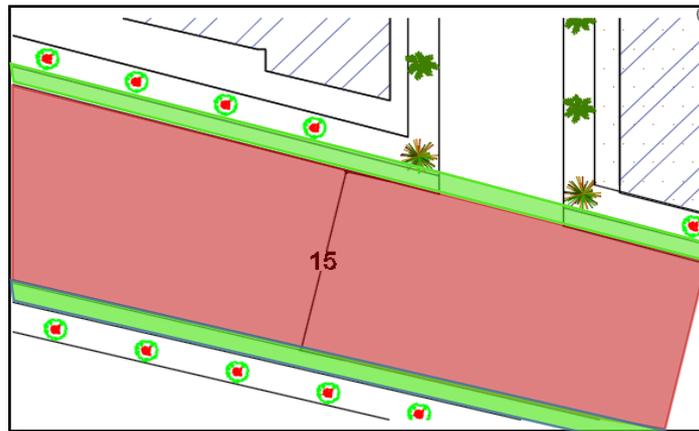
vue en plan de la rue Mohammed Belouizded après l'intervention
